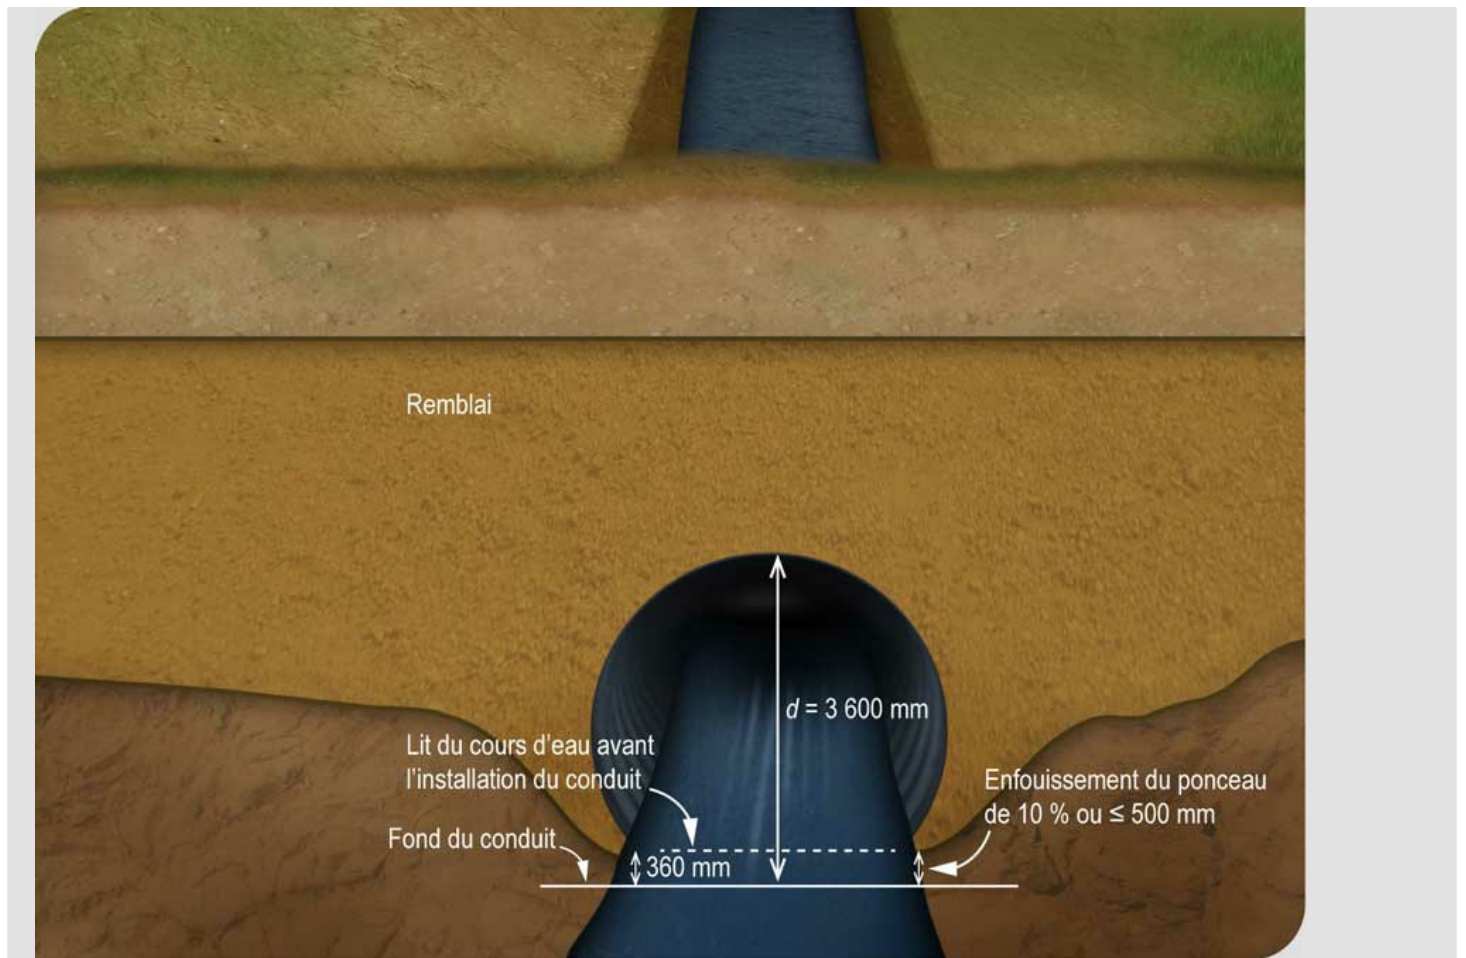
A Enfouissement du conduit d'un ponceau dans le lit d'un cours d'eau où le libre passage du poisson n'a pas à être assuré
